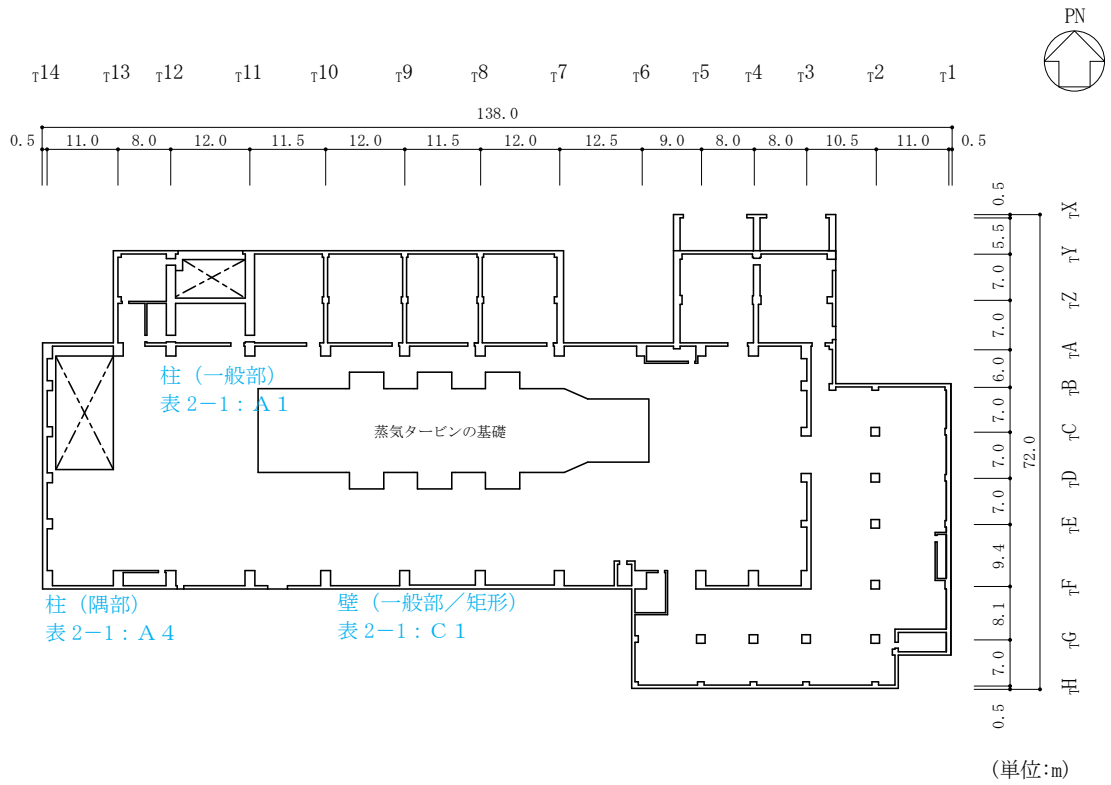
(4) タービン建物の概略平面図 (EL 20.6m)
